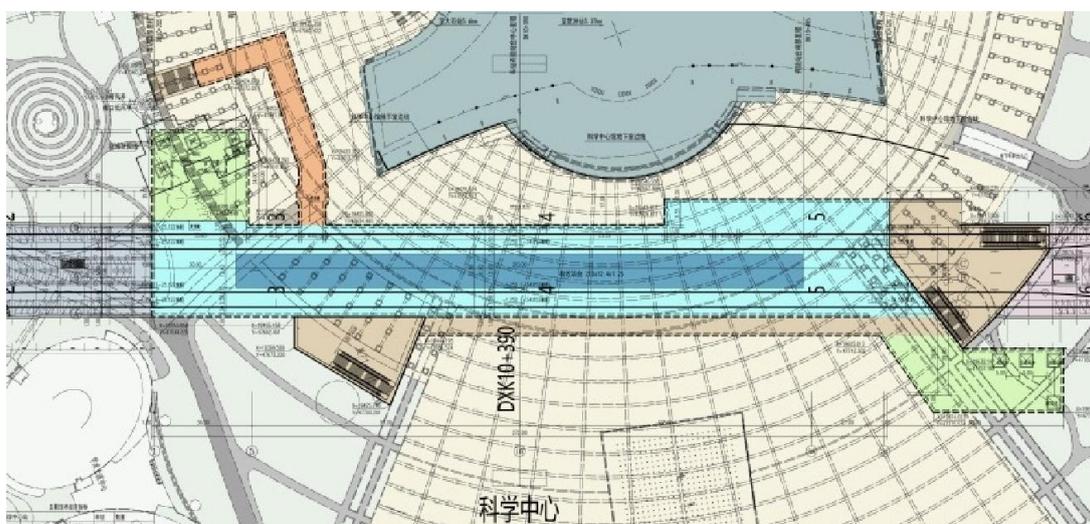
广州大学城站（原科学中心站）平面布置图
